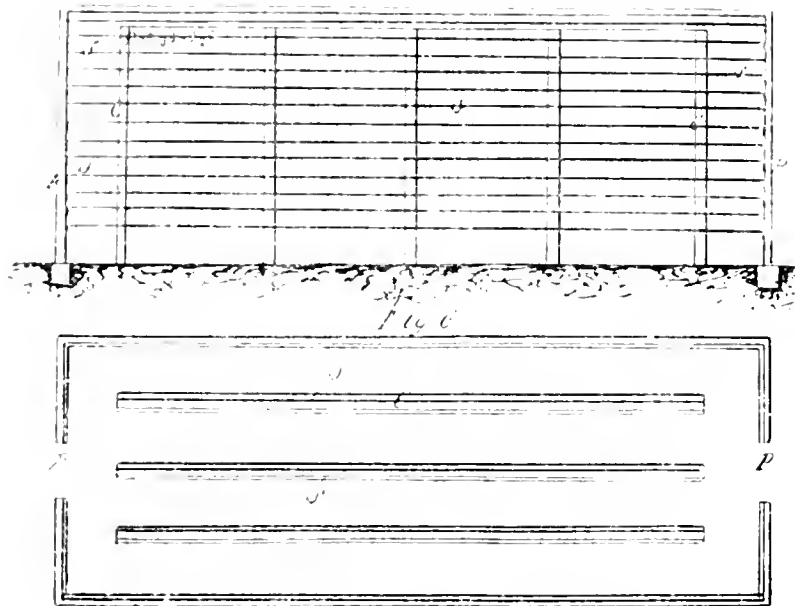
et 182. — Plans et coupe d'une charnière de conservation. (181 coupe longitudinale, 182 plan).
